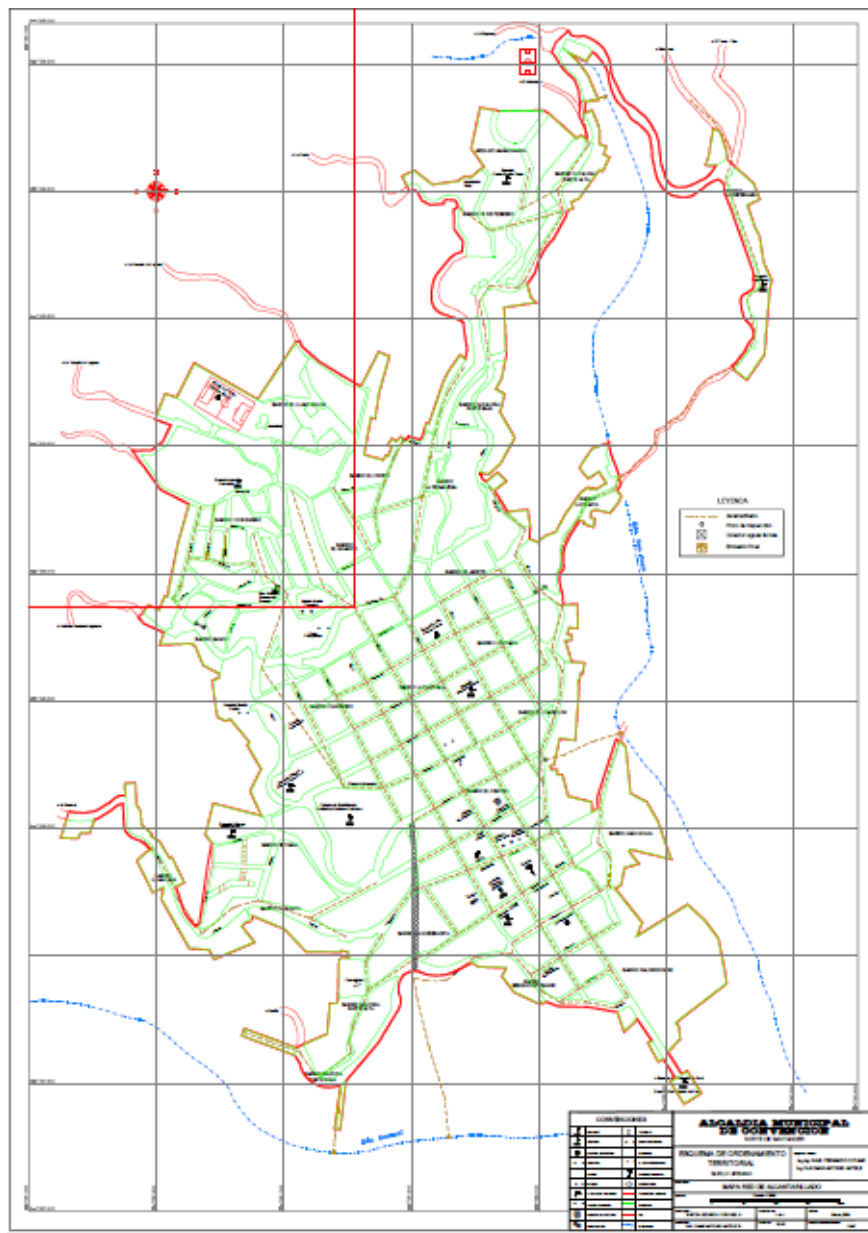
Planos del sistema de alcantarillado. EOT, 2004.
